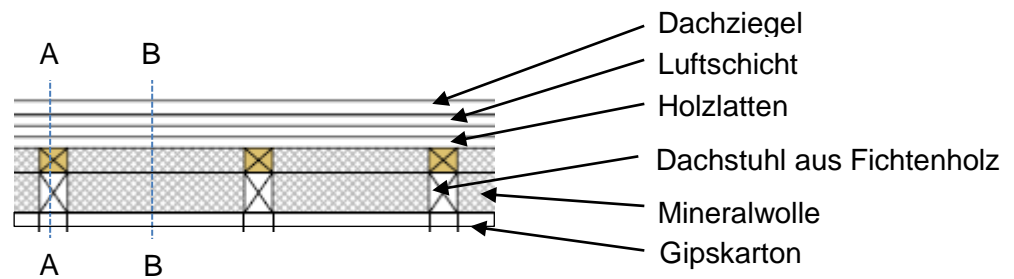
Dachaufbau (Polierplan Burg Rabenstein Längsschnitt 15.10.2007)
